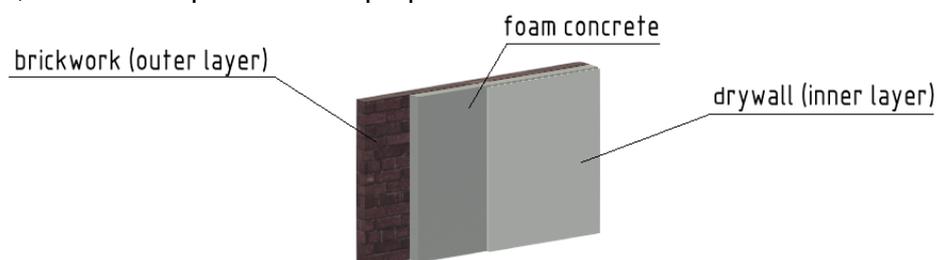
Конструкция кирпичной стены с теплоизоляционным пенобетоном
